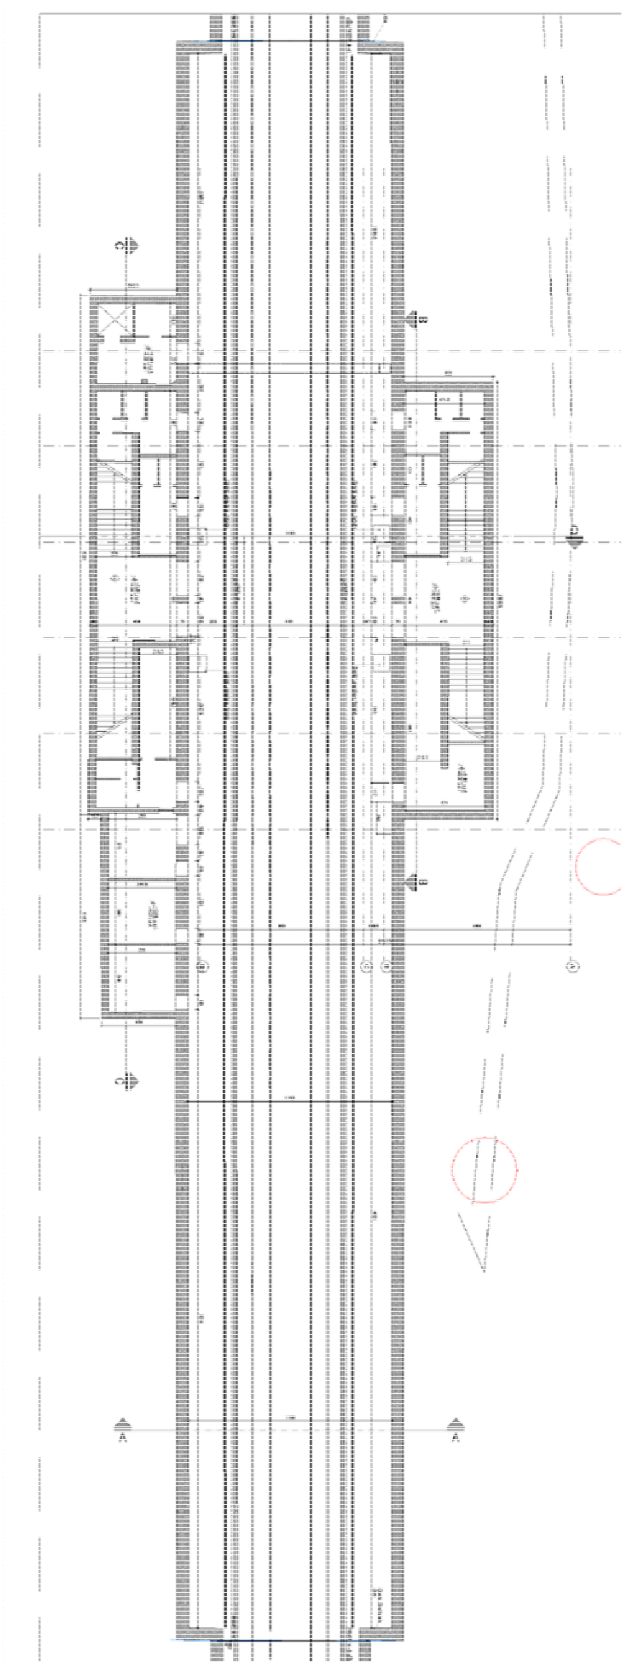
Pianta dell'interrato – Stato di fatto
